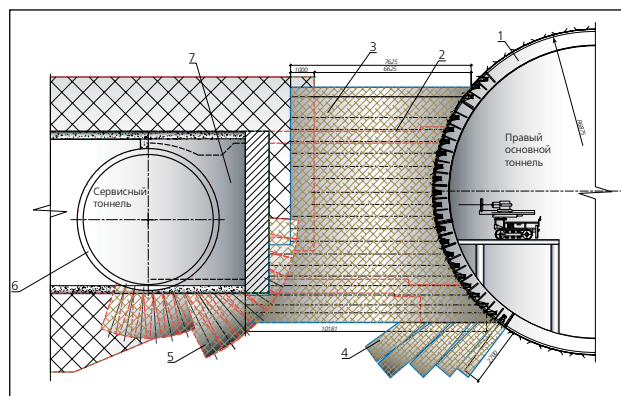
Укрепление грунтов по сбойке № 5: 1 – обделка основного тоннеля; 2 – проектный контур штольни; 3 – зона грунта, закреплённого горизонтальными ГЦС из основного тоннеля; 4 – наклонные ГЦС из основного тоннеля; 5 – наклонные ГЦС из сервисного тоннеля; 6 – обделка сервисного тоннеля; 7 – технологический отход
